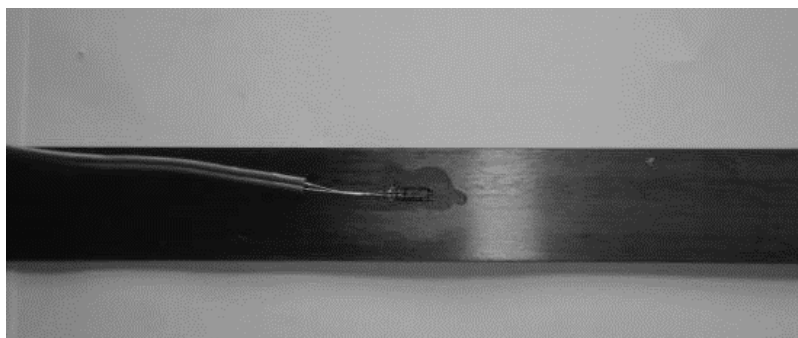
Posição dos extensómetros nas armaduras de aço (dimensões em mm).
